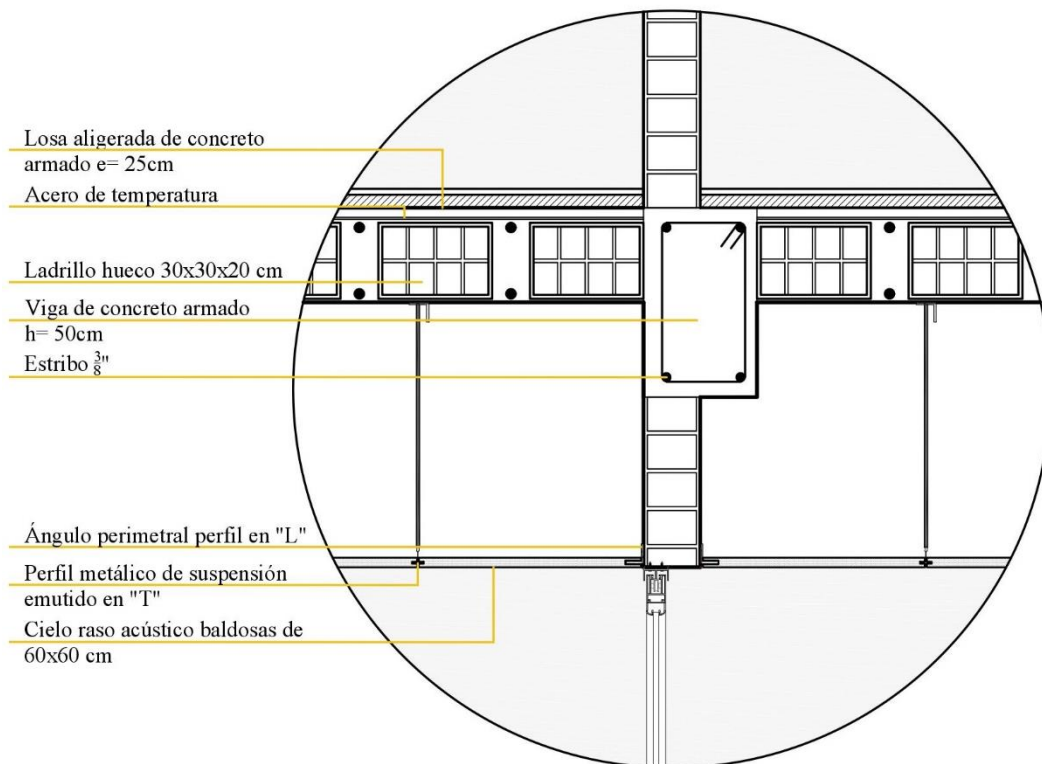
Detalle de losa aligerada y falso cielo raso. Fuente: Propia
